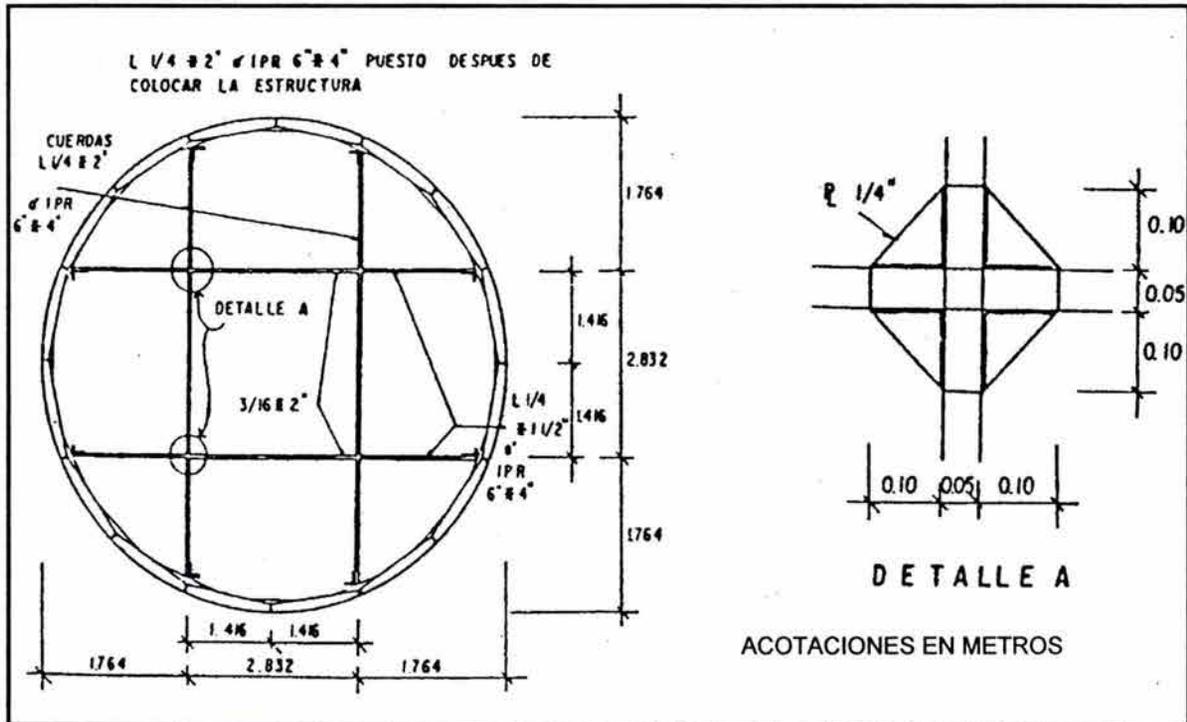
ESTRUCTURA METÁLICA INTERIOR DE LA CIMBRA
